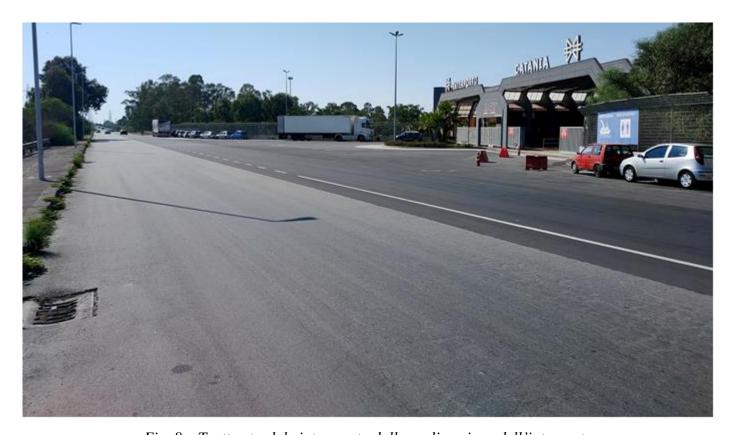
Tratto~stradale~interessato~dalla~realizzazione~dell'intervento
